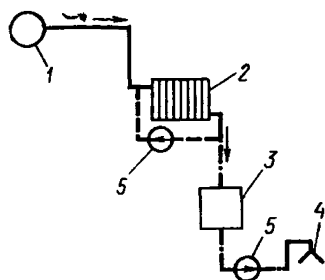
Схема с последовательной подачей геотермальной воды на отопление и горячее водоснабжение
